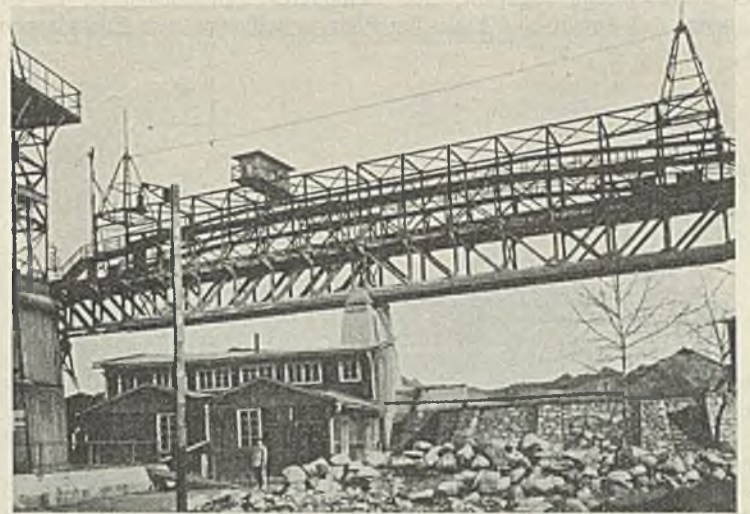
Die Mittelöffnungen der Sandentladebrücke bei Glückaufschacht mit dem Auflaufschienengerüst.
